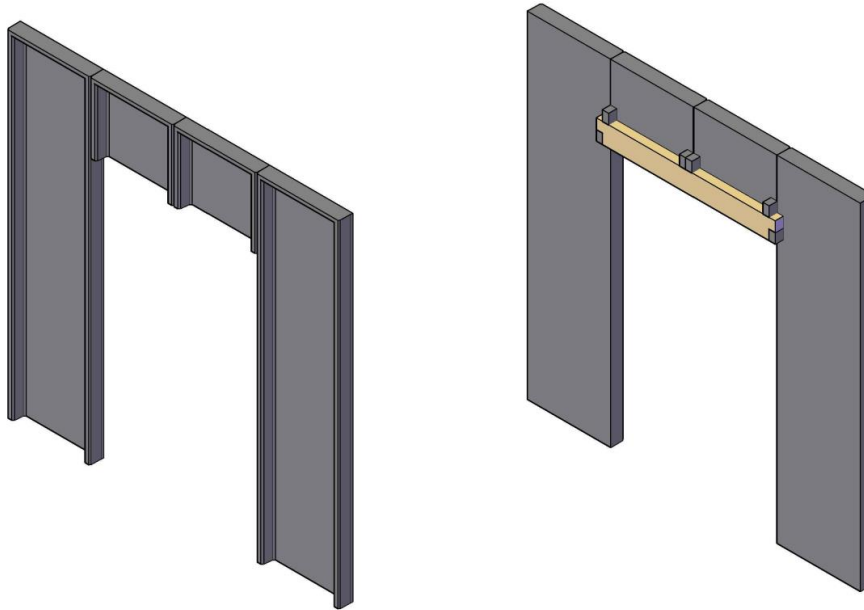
Vistas isométricas sectores de portones Izquierda 14a: Vista Exterior – Derecha 14b: Vista Interior
